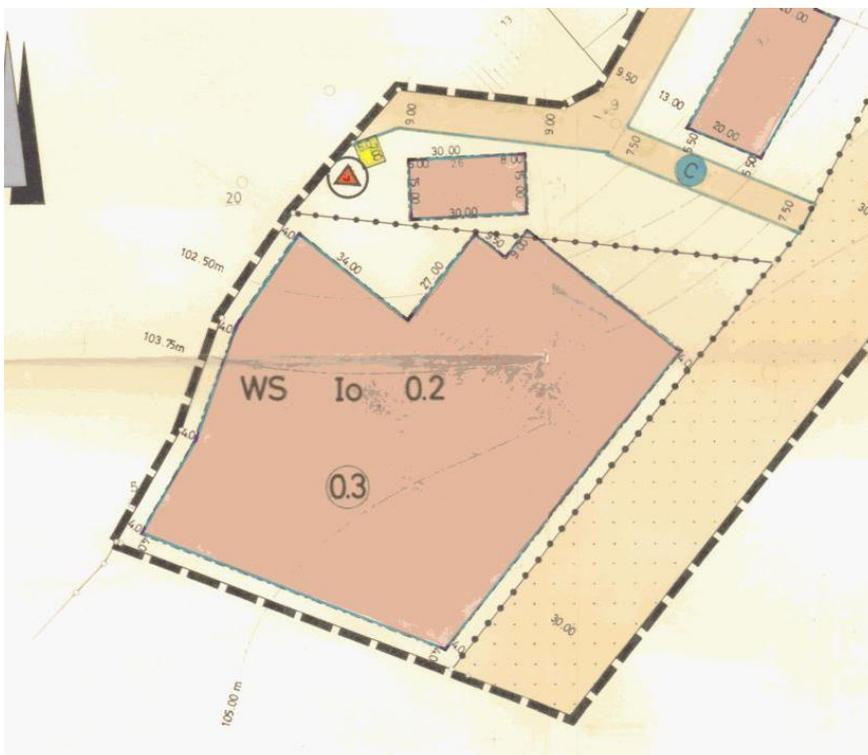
Bebauungsplanausschnitt Nr. 1 "Steinbult"
